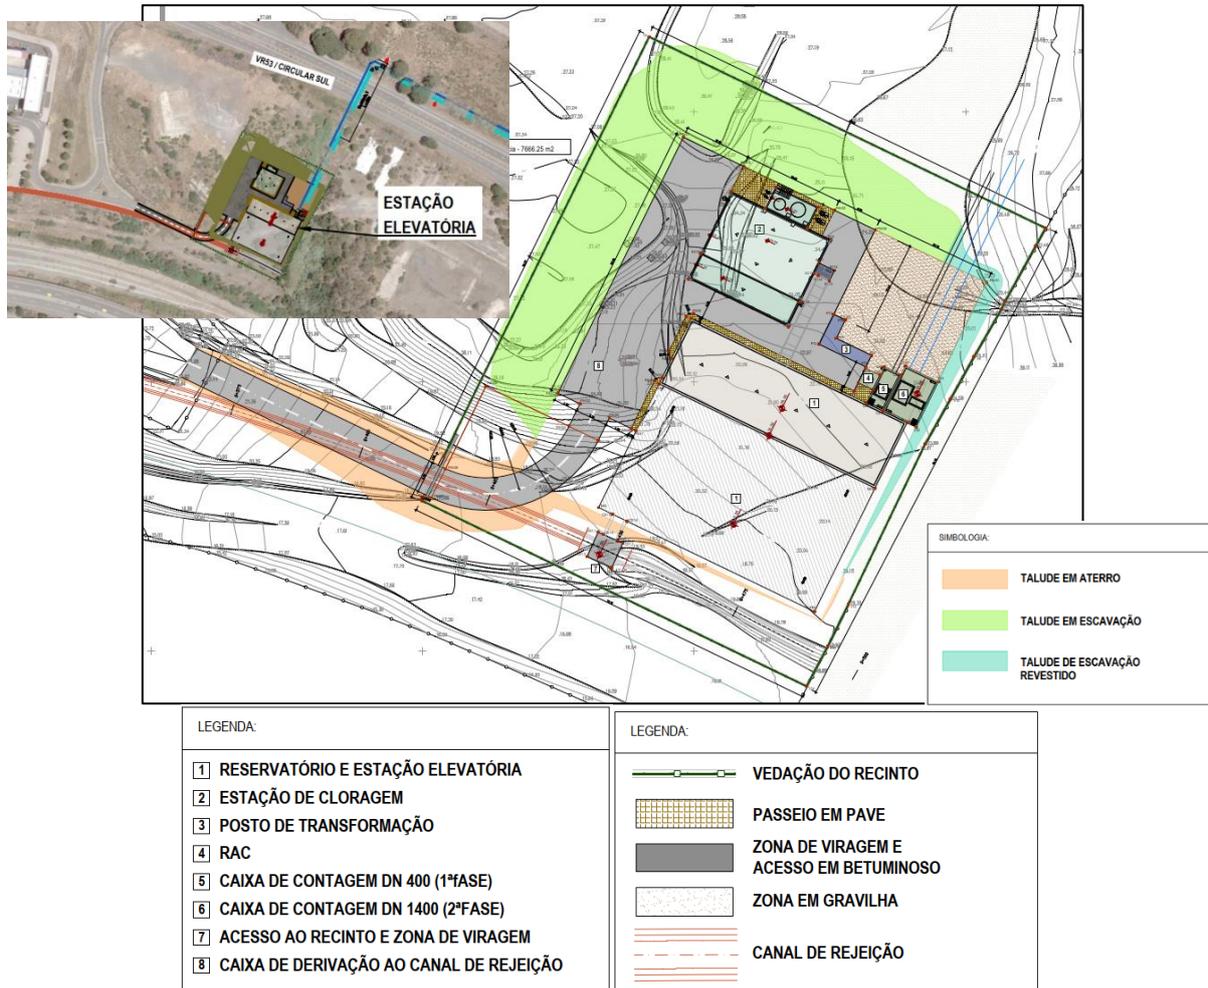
Implantação Geral da Estação Elevatória GNL (sem escala).
